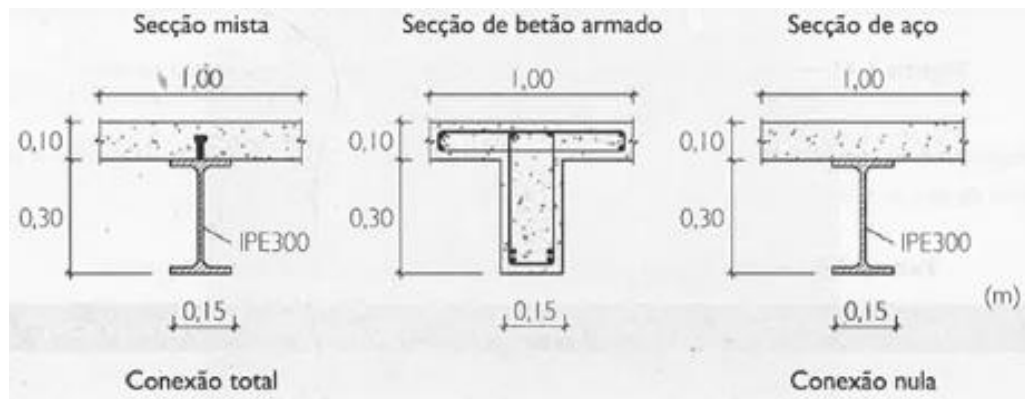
Soluções estruturais para vigas (Calado & Santos, 2013)
